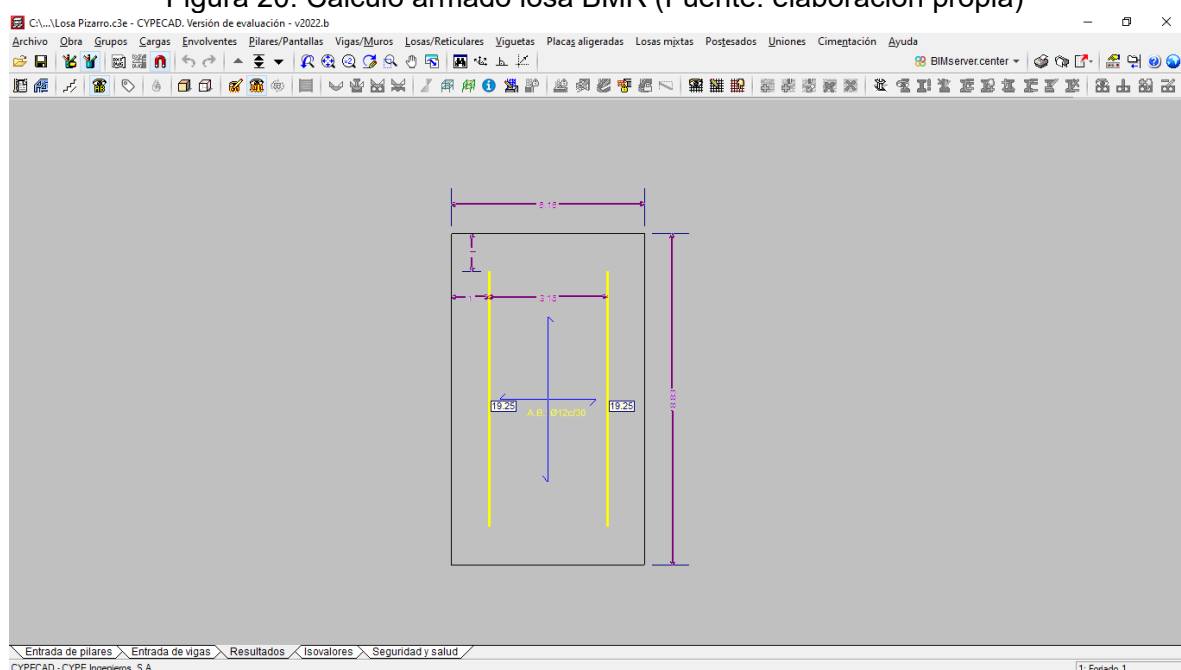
Cálculo armado losa Pizarro (Fuente: elaboración propia)
